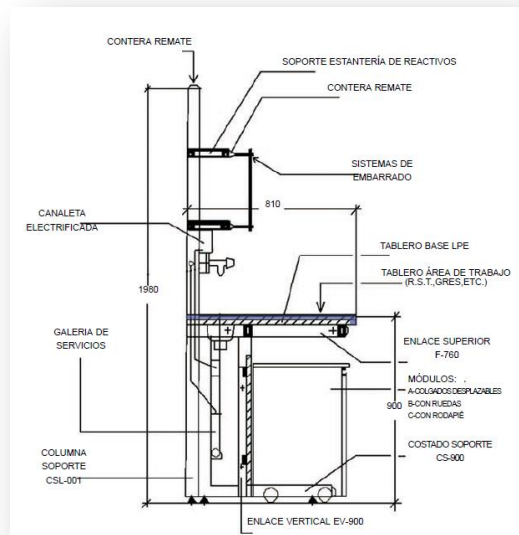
Sistema constructivo mesa mura sección tipo.
